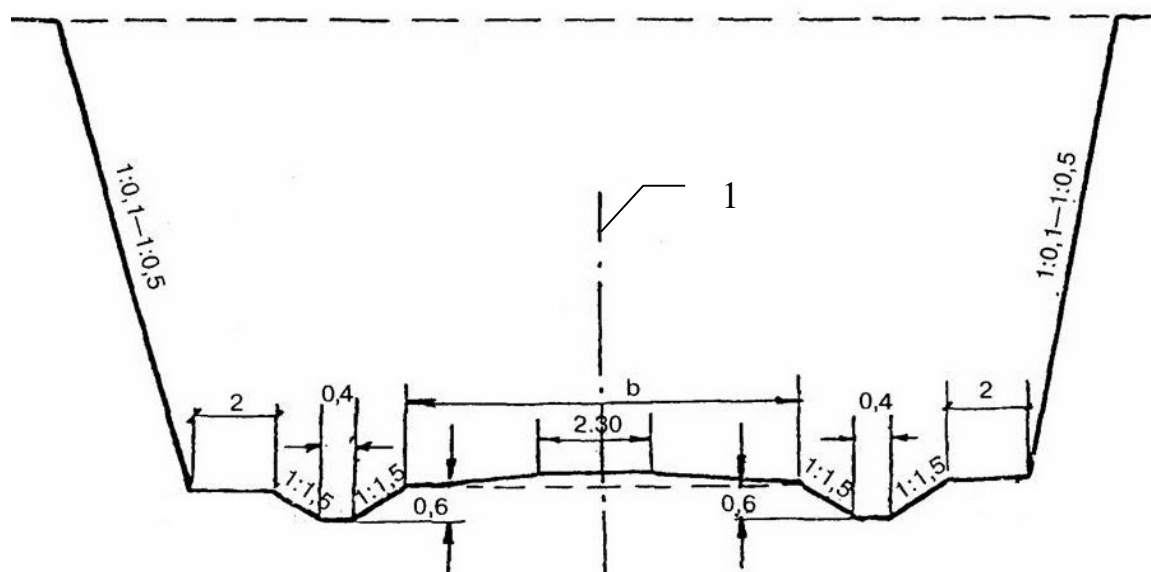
Поперечный профиль выемки глубиной до 12 м: 1 – ось пути; b – ширина основной площадки земляного полотна [25]
